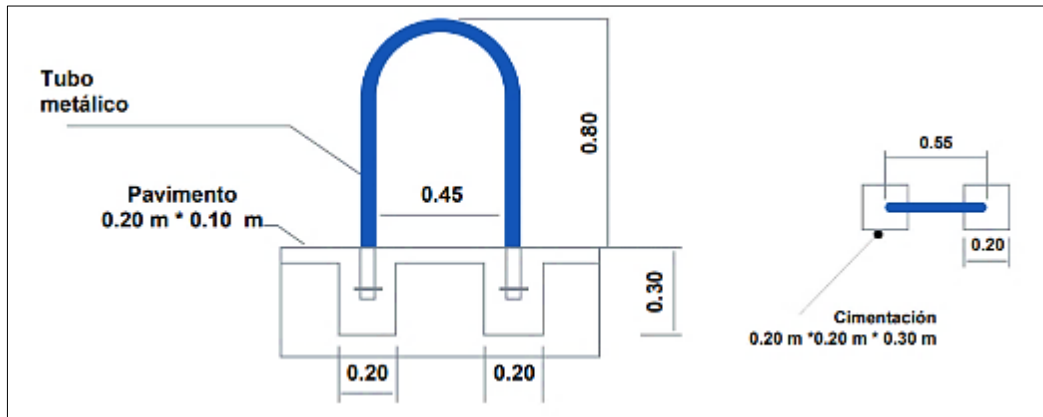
Plano de detalle para tubo de cicloparqueaderos.
